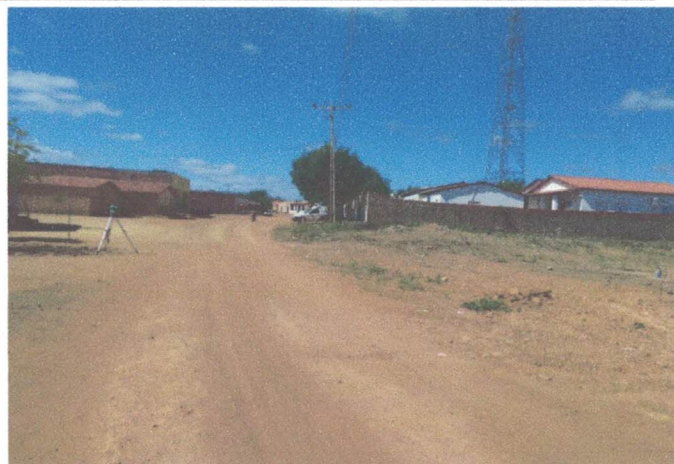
RUA PROJETADA - TRECHO 3
